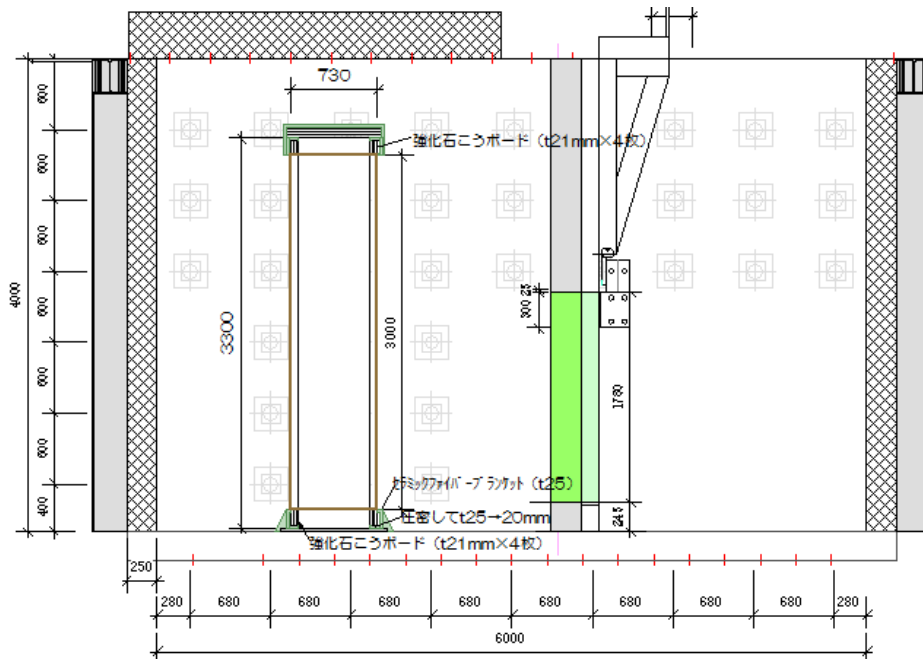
試験体配置図 (A-A断面図 : L250C_60)
